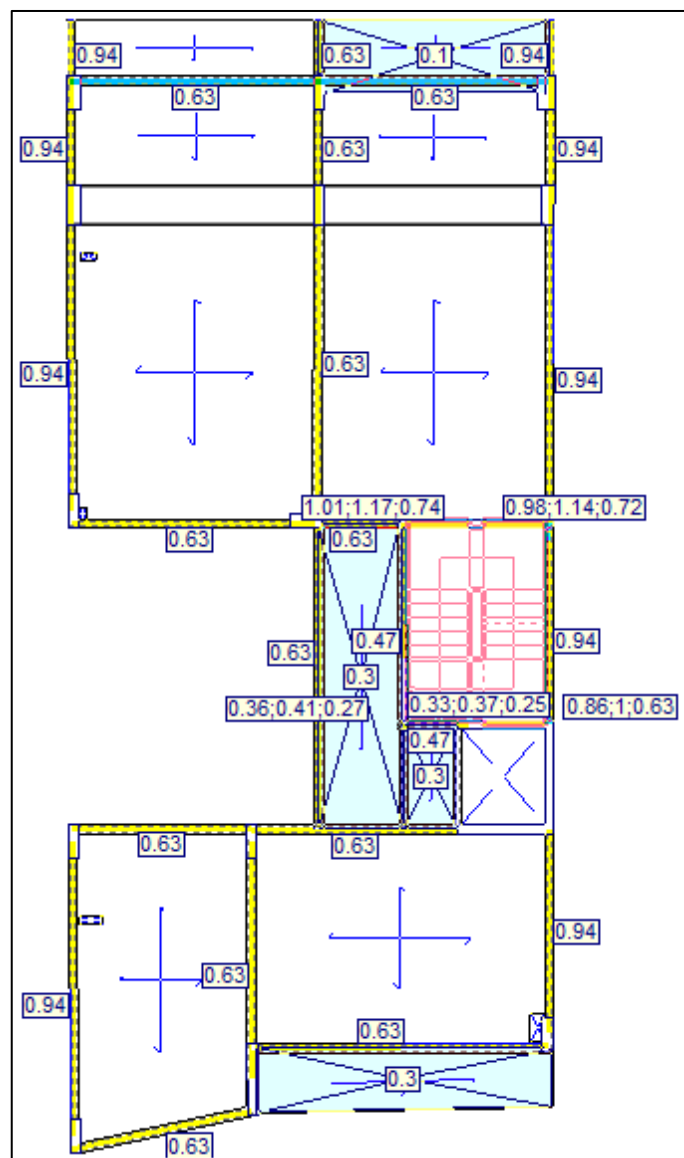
Introducción de sobrecargas de Uso por local.
